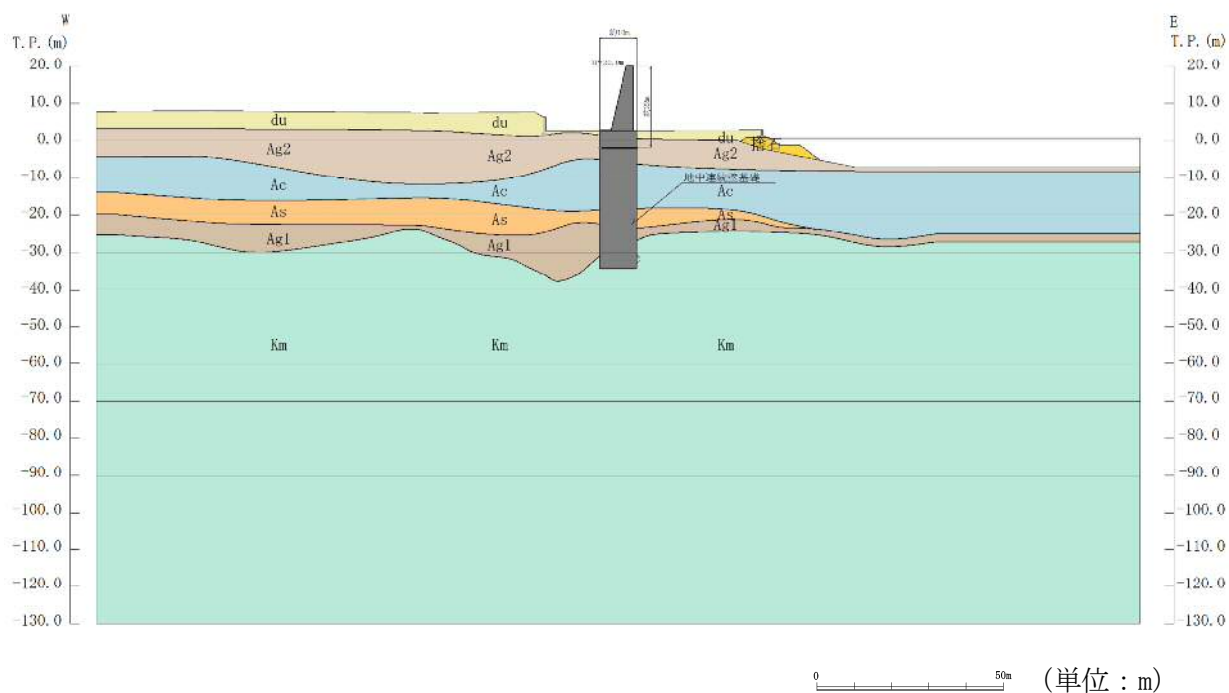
(4) 鉄筋コンクリート防潮壁 評価対象断面図 (④-④断面)
